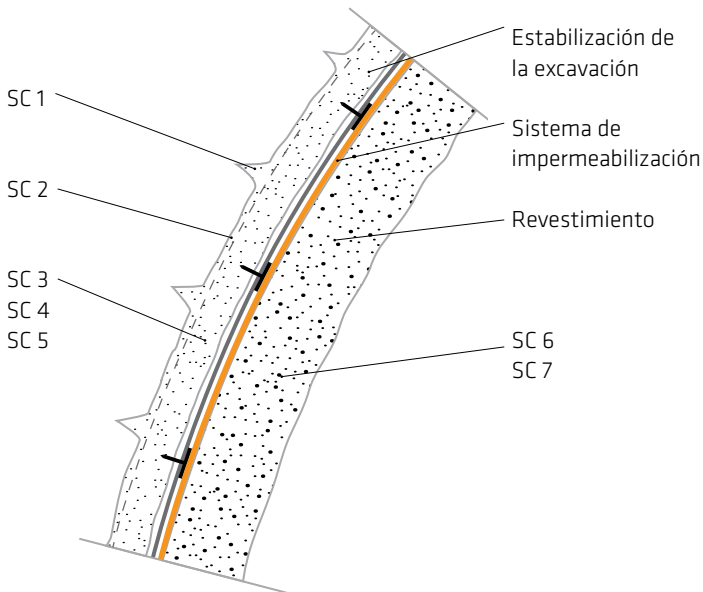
Tipos de hormigón proyectado según SN 531 198 (Suiza)
